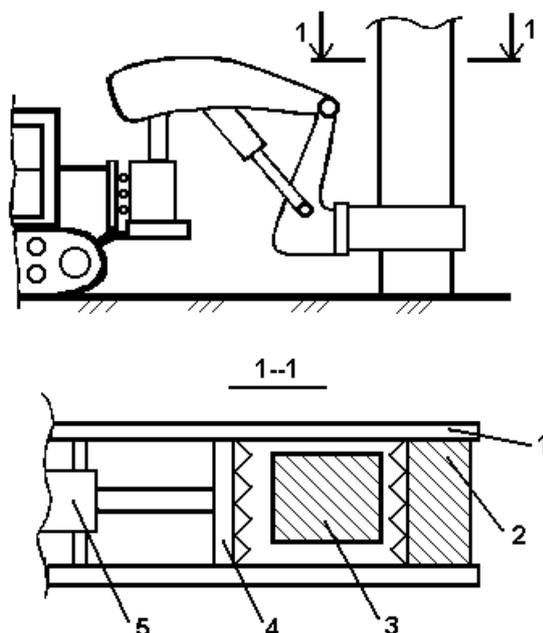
Устройство для скалывания бетона колонн, свай и т.п.
